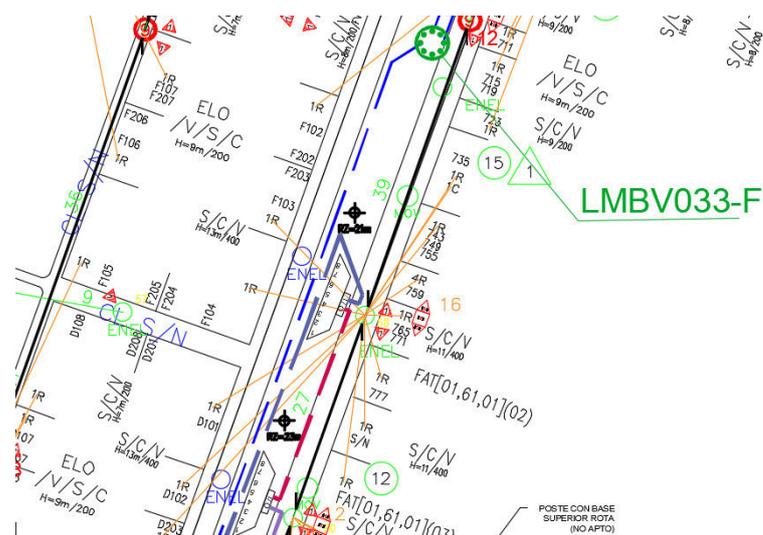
Vista ampliada del plano AS-BUILT i3. Fuente: Elaboración propia
